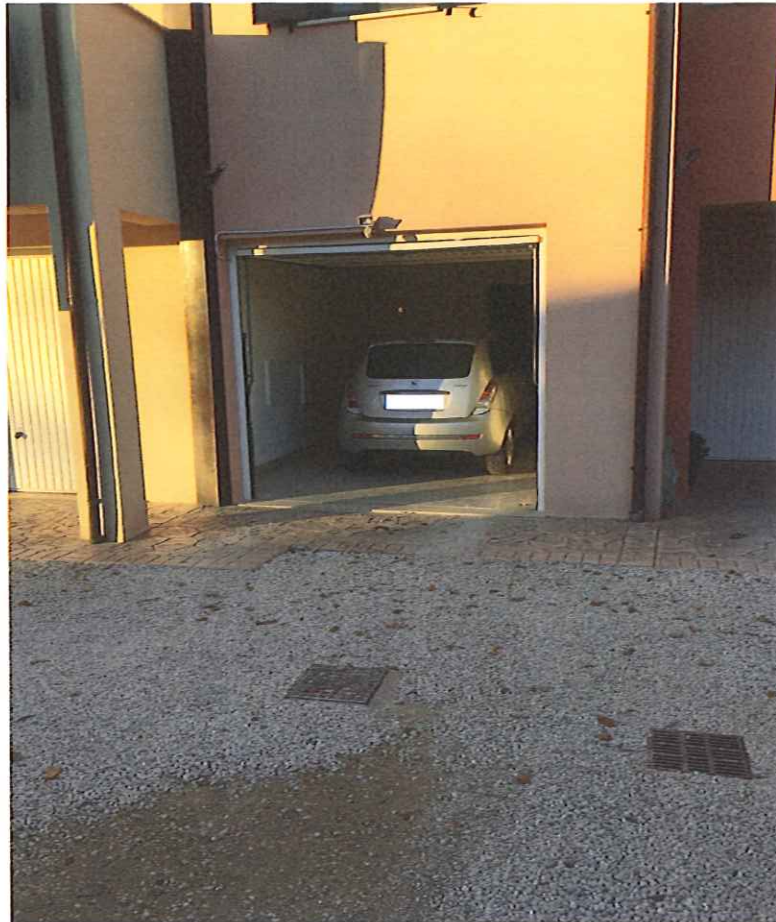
particolare autorimessa al piano seminterrato
